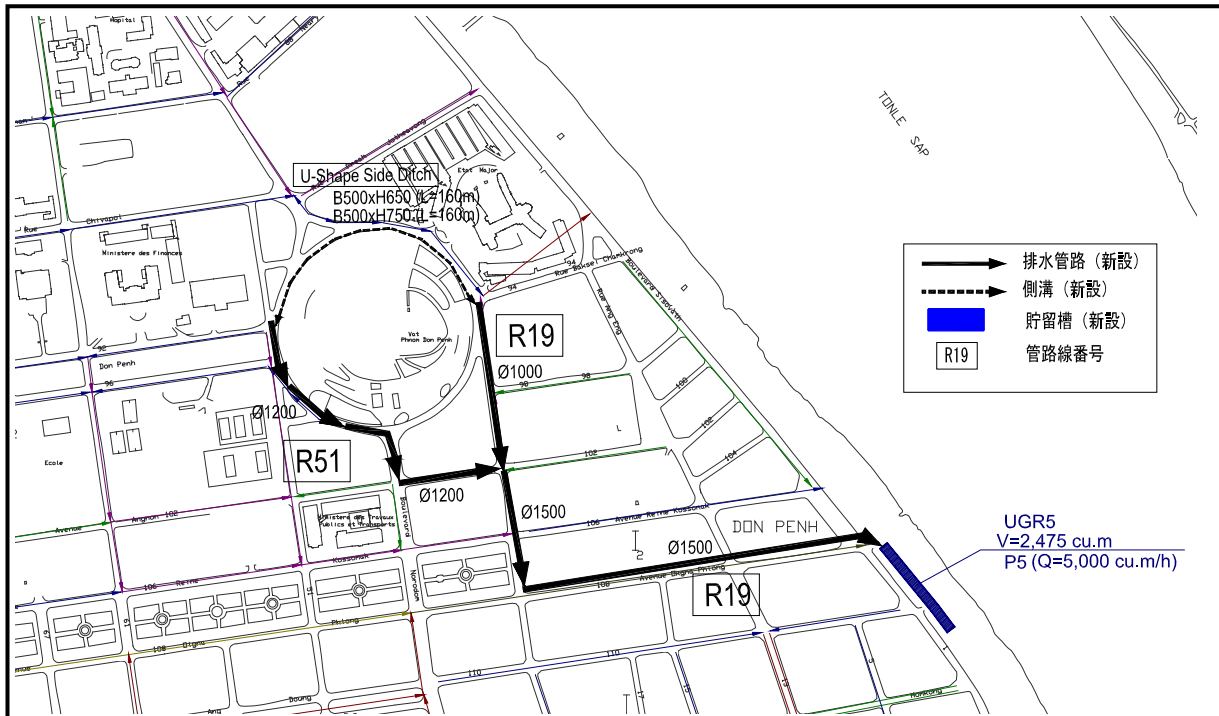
計画排水施設配置図（ワットプノン排水区）
